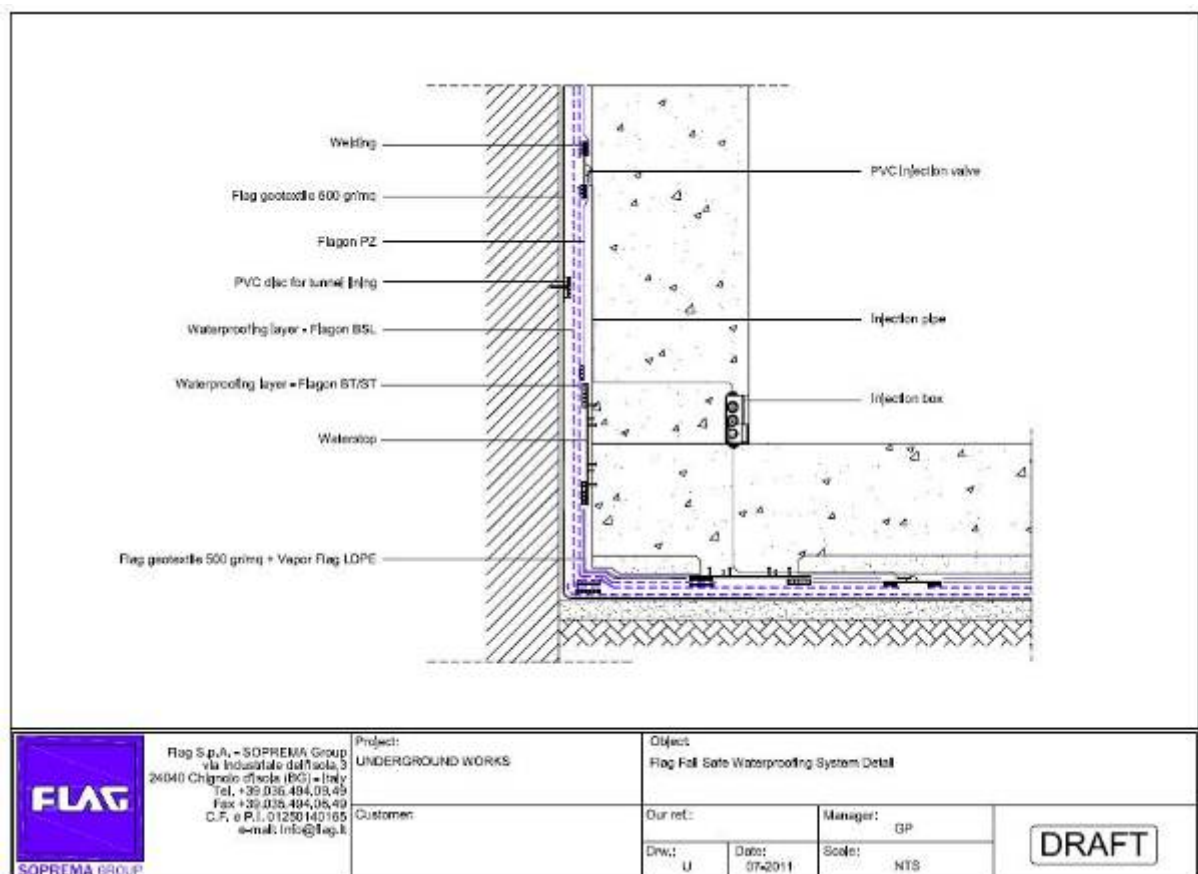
Detalhes do sistema de impermeabilização sem falha.
